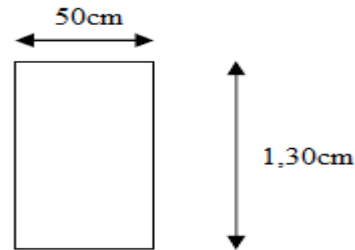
Schéma d'une coupe transversale en travée et en appui
